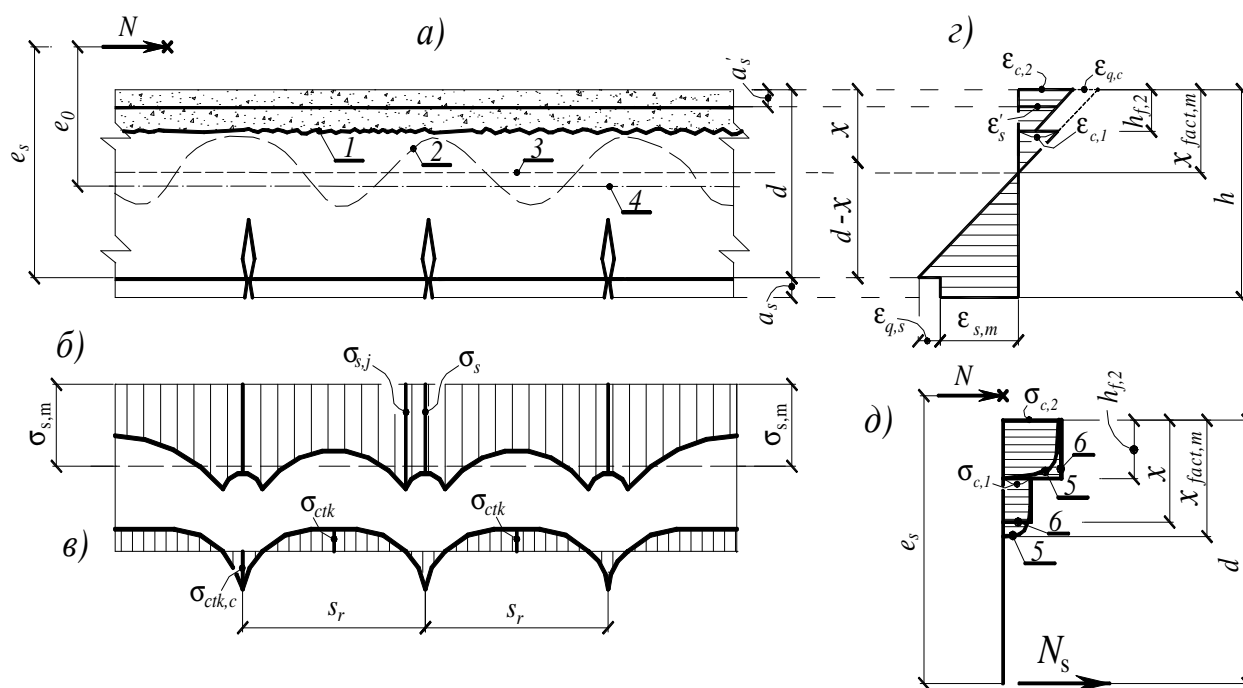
Типові картини деформування бетону і арматури в залізобетонних позацентрово стиснутому елементі з тріщинами при врахуванні ефекту, пов'язаного з порушенням суцільності бетону та умовного зосередженого зсуву між бетонами і між арматурою та бетоном: *a* – схема утворення тріщин; *б, в* – епюри напружень у розтягнутій арматурі і розтягнутому бетоні; *г* – гіпотеза середніх деформацій у поперечному перерізі складеного залізобетонного елемента; *д* – внутрішні зусилля в перерізі з тріщиною
